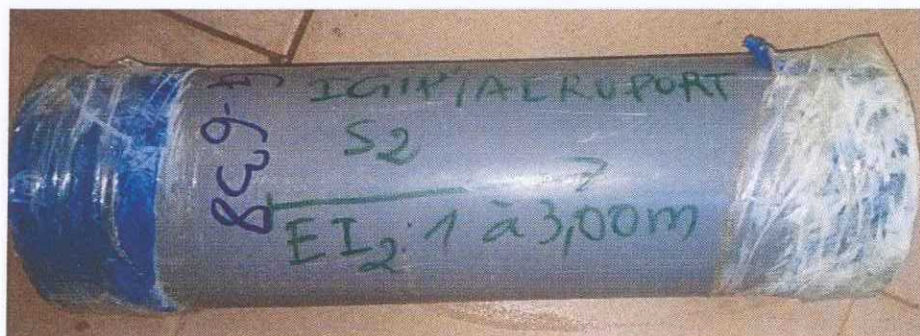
Photo des couches géologiques de SC2 entre 0,00 m et 3,00 m
